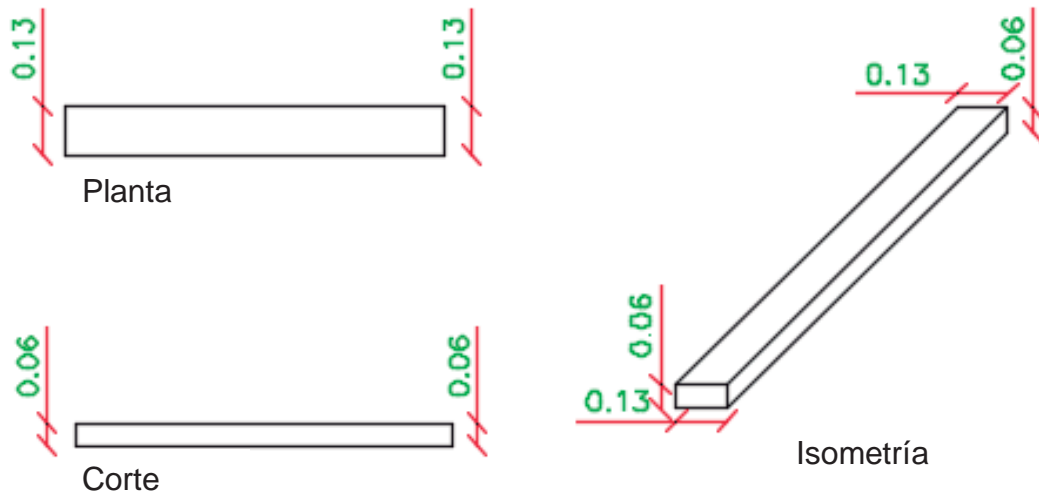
Bloque plástico reciclado tipo viga - AutoCAD, 2018
